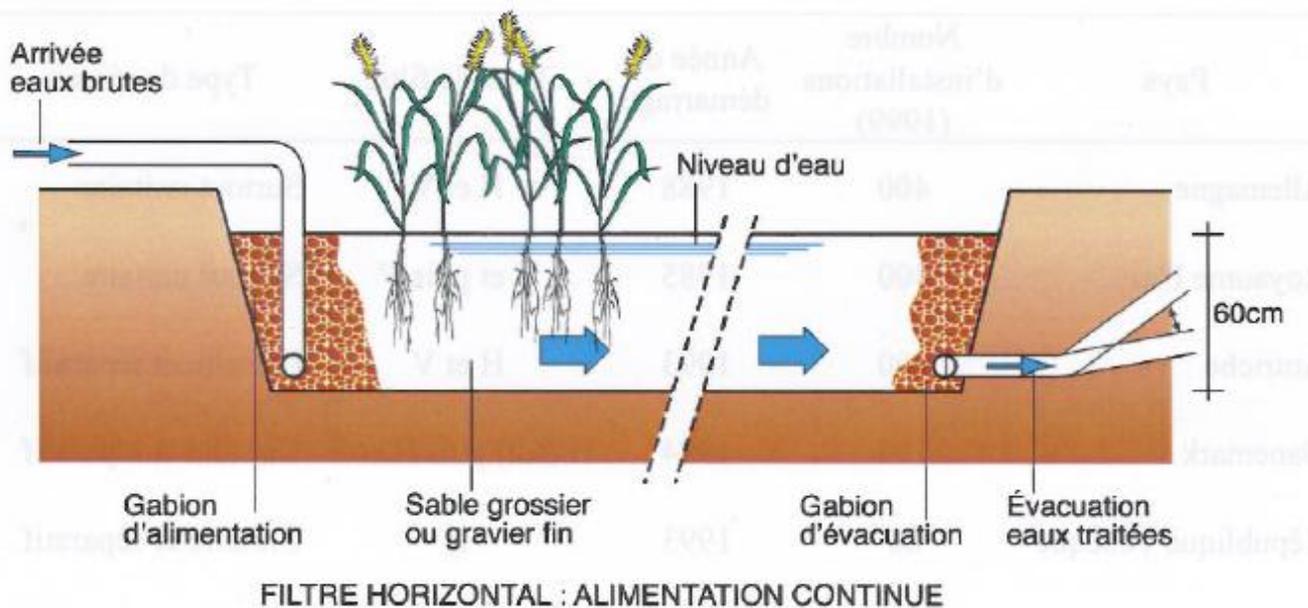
Schéma d'un filtre horizontal en coupe transversale
